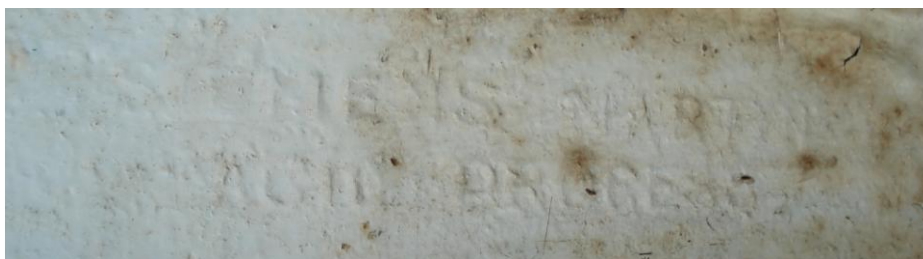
186: Corrosão uniforme em pilar da fachada lateral esquerda - Elétrica
